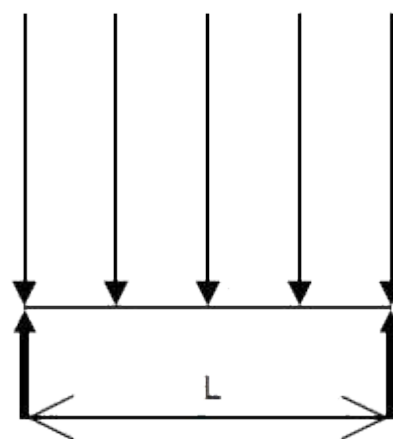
, Таблица 4. Нагрузки на кровельные панели с минераловатным утеплителем при схеме нагружения — статически определяемая однопролетная балка.
